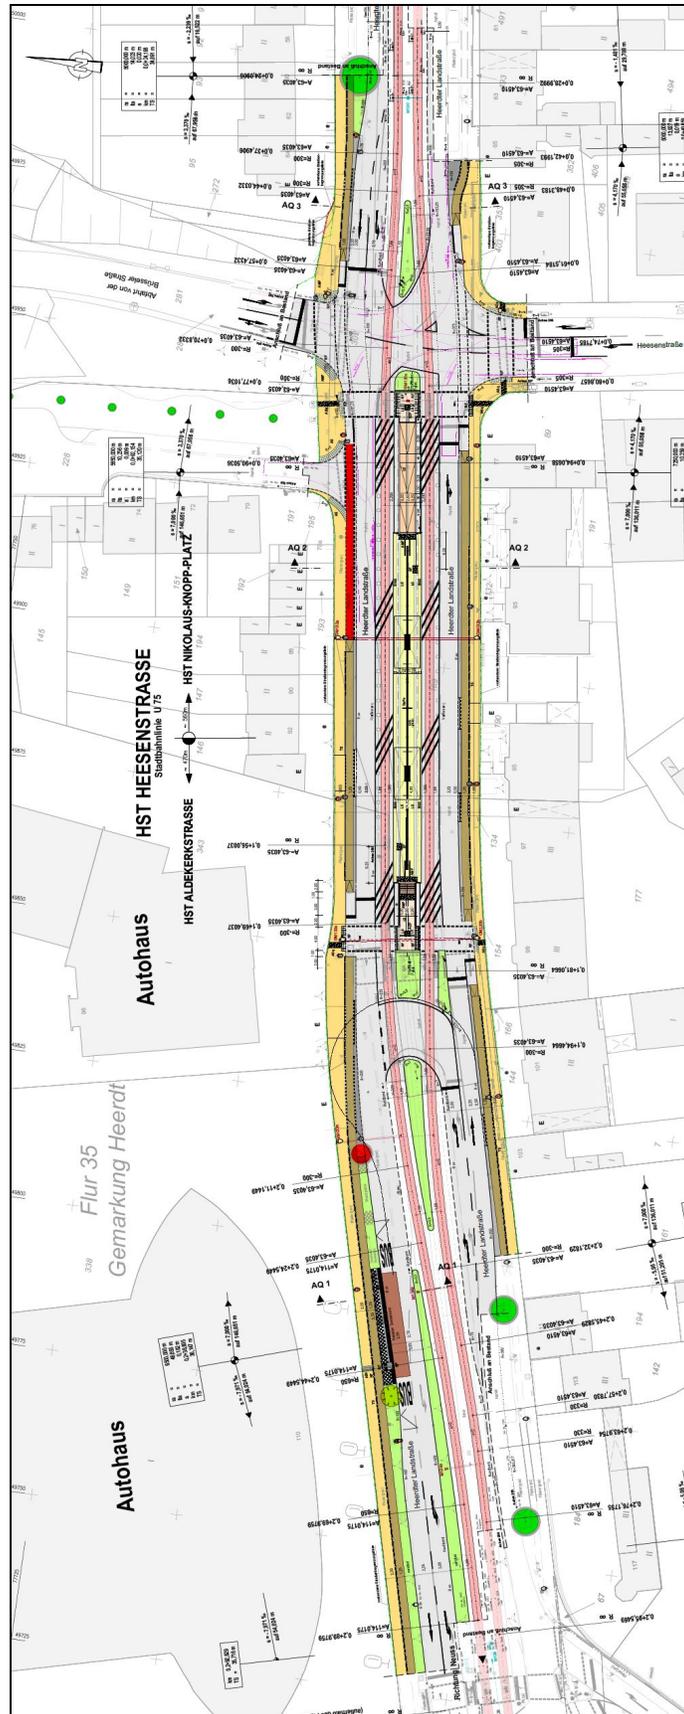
Geplanter Mittelbahnsteig Heesenstraße
